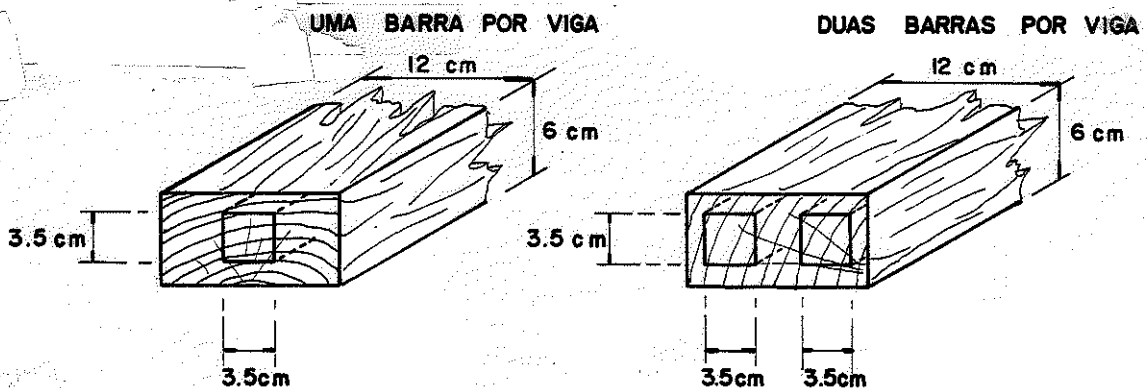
SEÇÃO TRANSVERSAL DAS VIGAS DE MADEIRA
